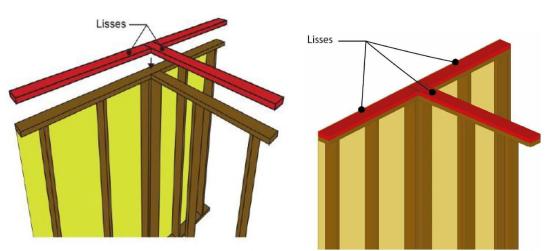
Exemple de mise en œuvre de la lisse haute sur un assemblage mur intérieur / mur extérieur
